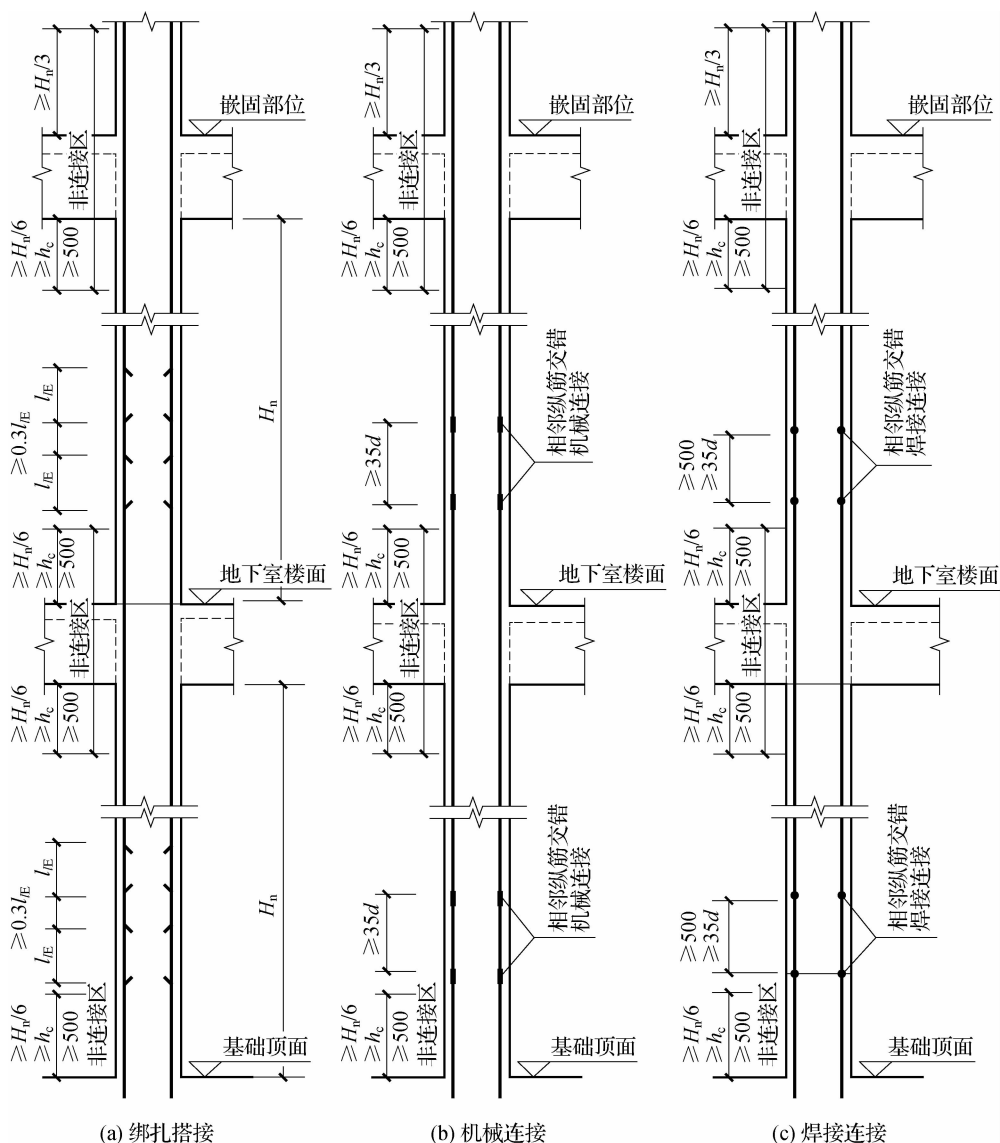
地下室抗震 KZ 纵向钢筋连接构造
